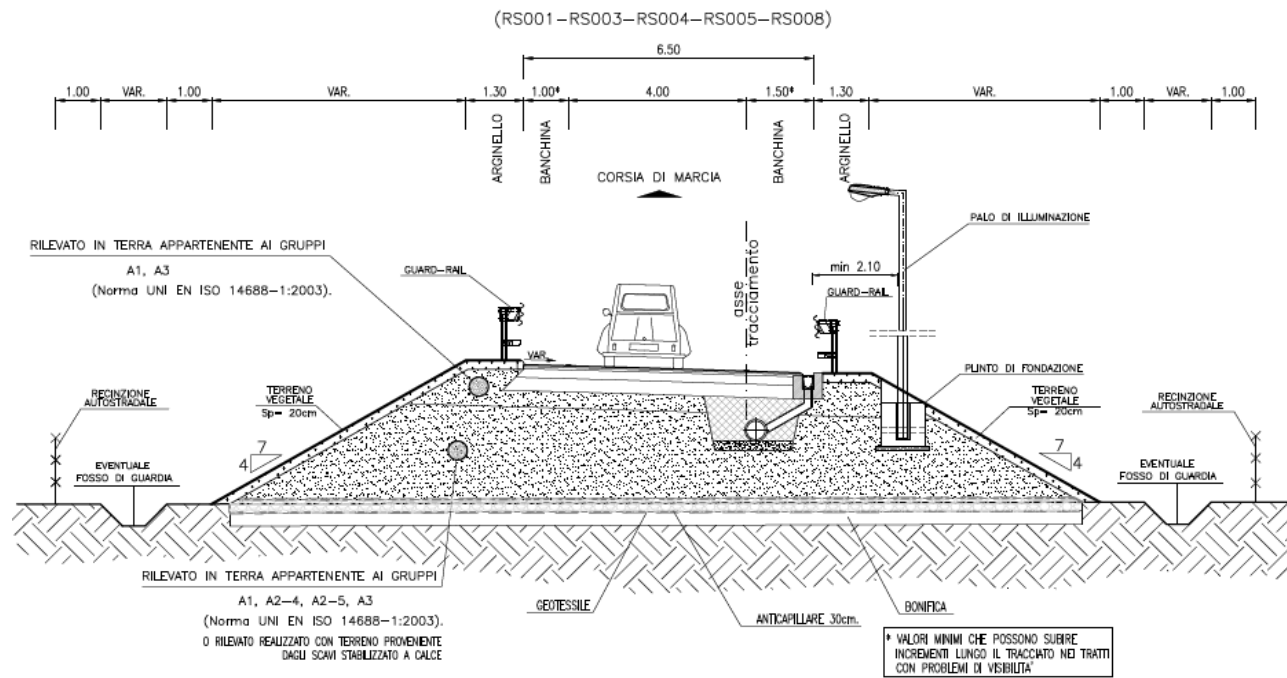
Sezione tipo monodirezionale
